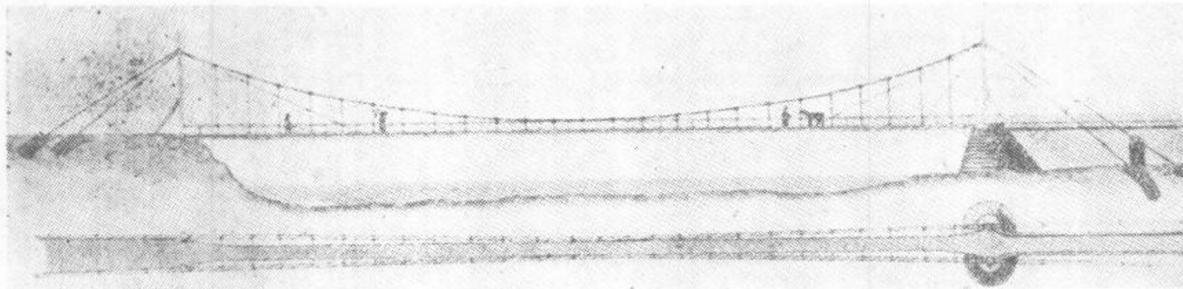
英格兰德赖伯桥 (Dryburgh Bridge) , 1817年
